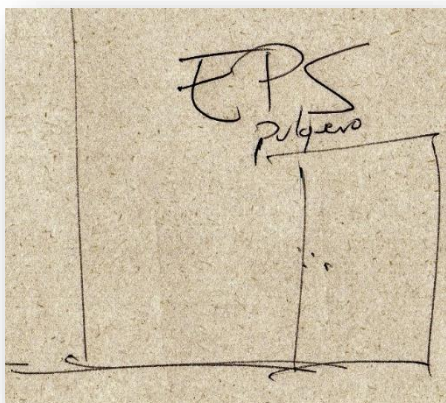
plano fachada de la EPS o pulguero, egresado EB
